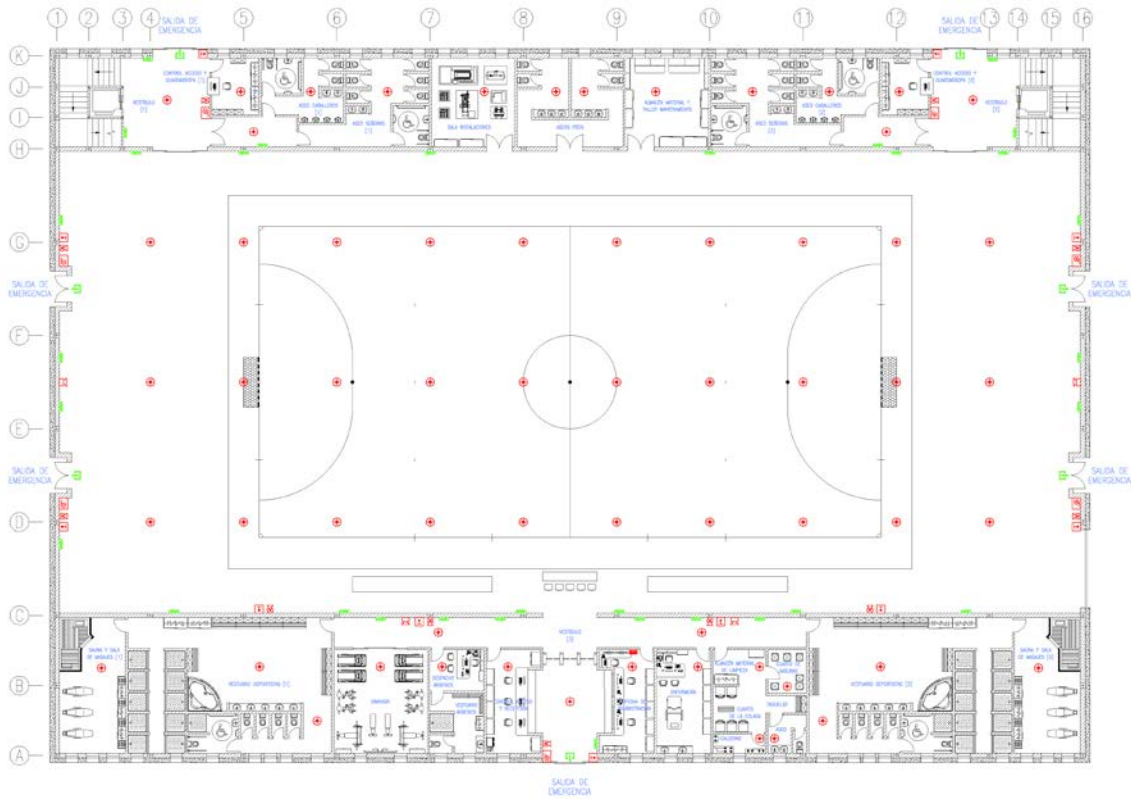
Distribución en planta +0.00 Protección contra Incendios.
